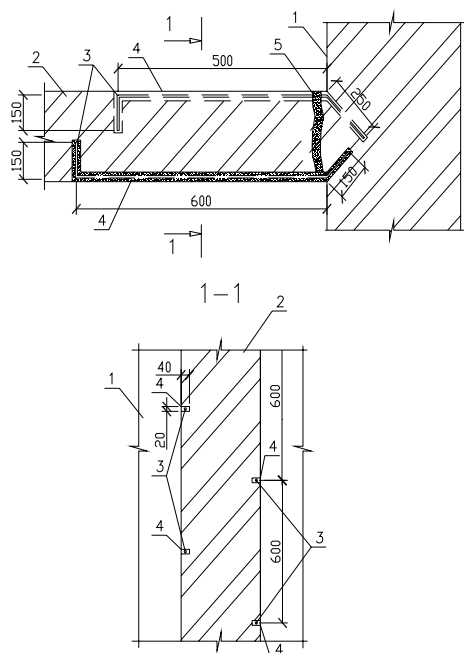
Узел усиления сопряжения внутренних и наружных стен : 1 – наружная стена, 2 – внутренняя стена, 3 – скоба из арматуры класса А-III, d=10мм, устанавливаемая на цементно-песчаном растворе М100, 4 – штроба сечением 20х40мм, 5 – существующая трещина в узле сопряжения стен (подлежит инъецированию)
